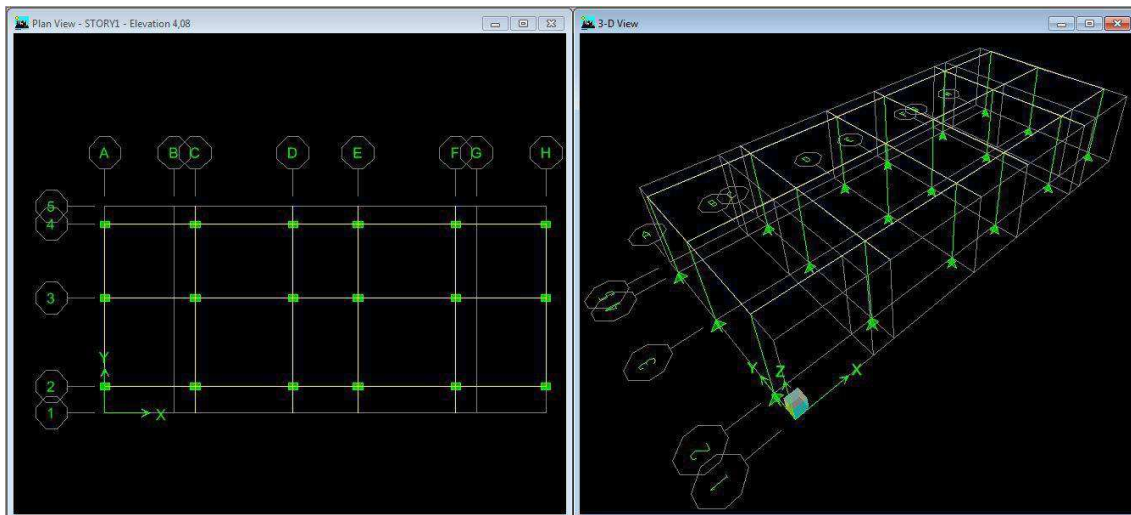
Vue en plan et en 3D des portiques de rez-de-chaussée.
